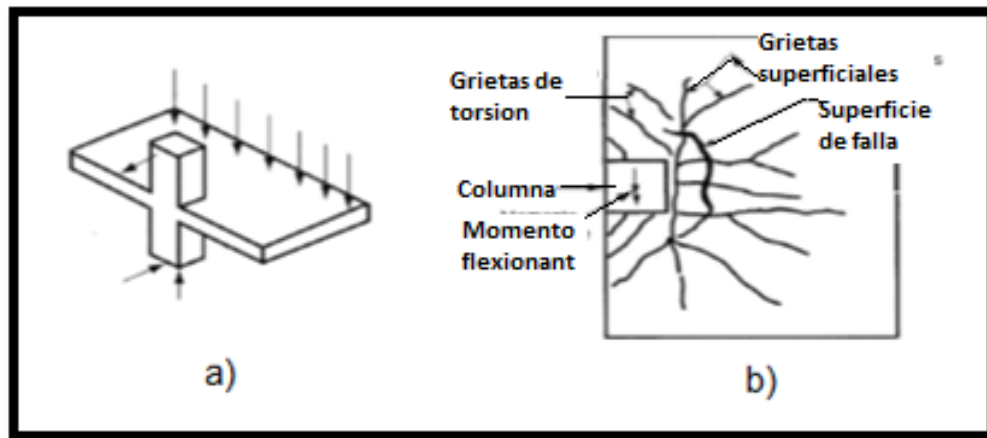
Especimen de ensayo y configuración de agrietamiento en una losa conectada a una columna de borde.
